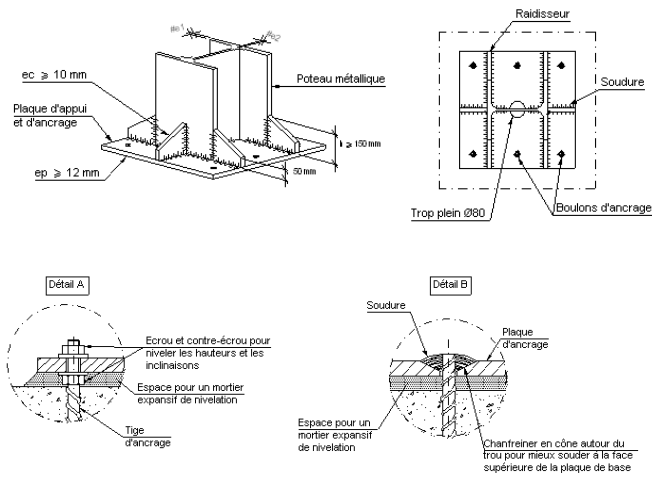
Détails technique de l'encastrement d'un poteau métallique.
